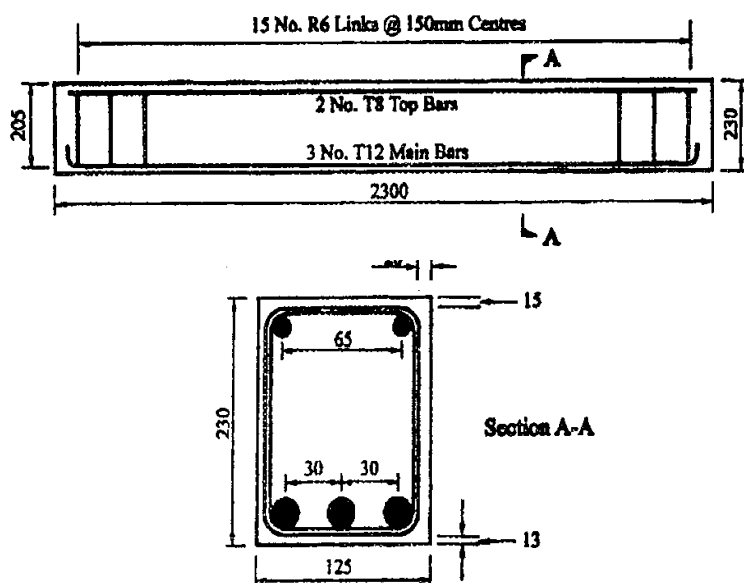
Dimensions des éprouvettes (d'après [58])
